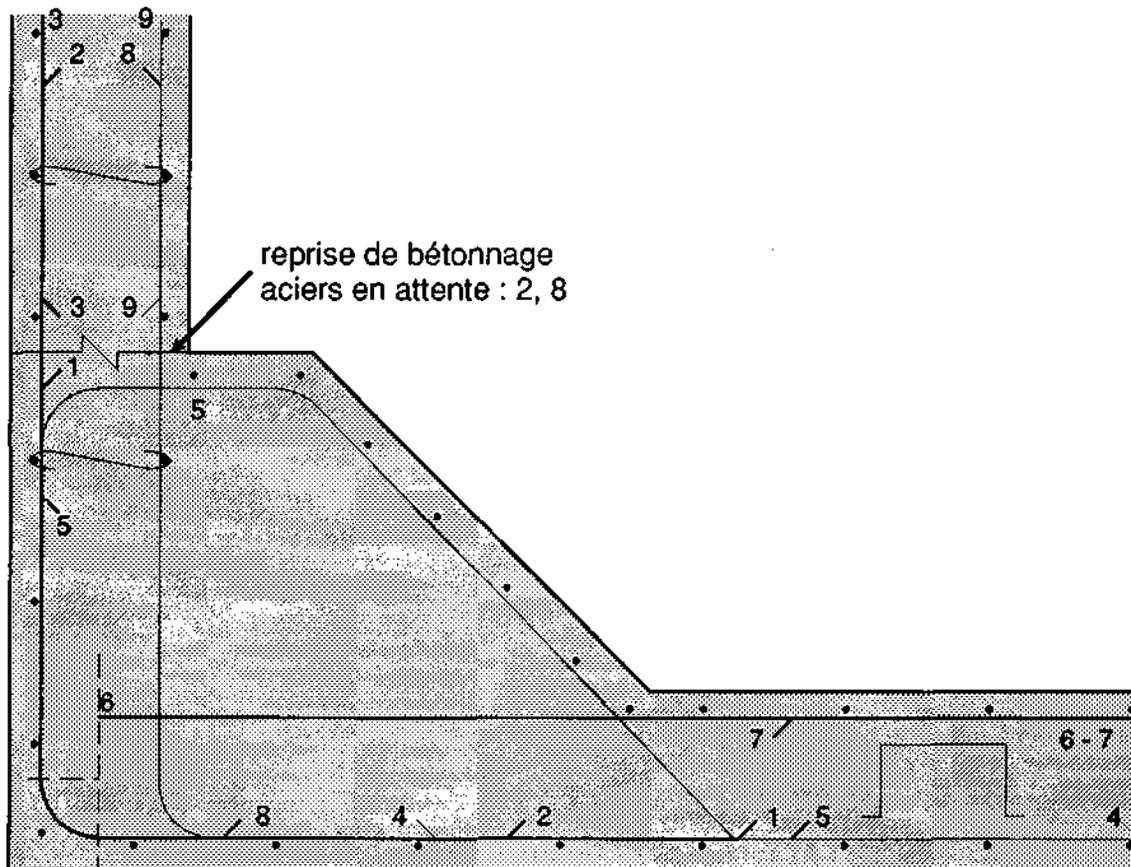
Exemple de ferrailage d'un angle inférieur
